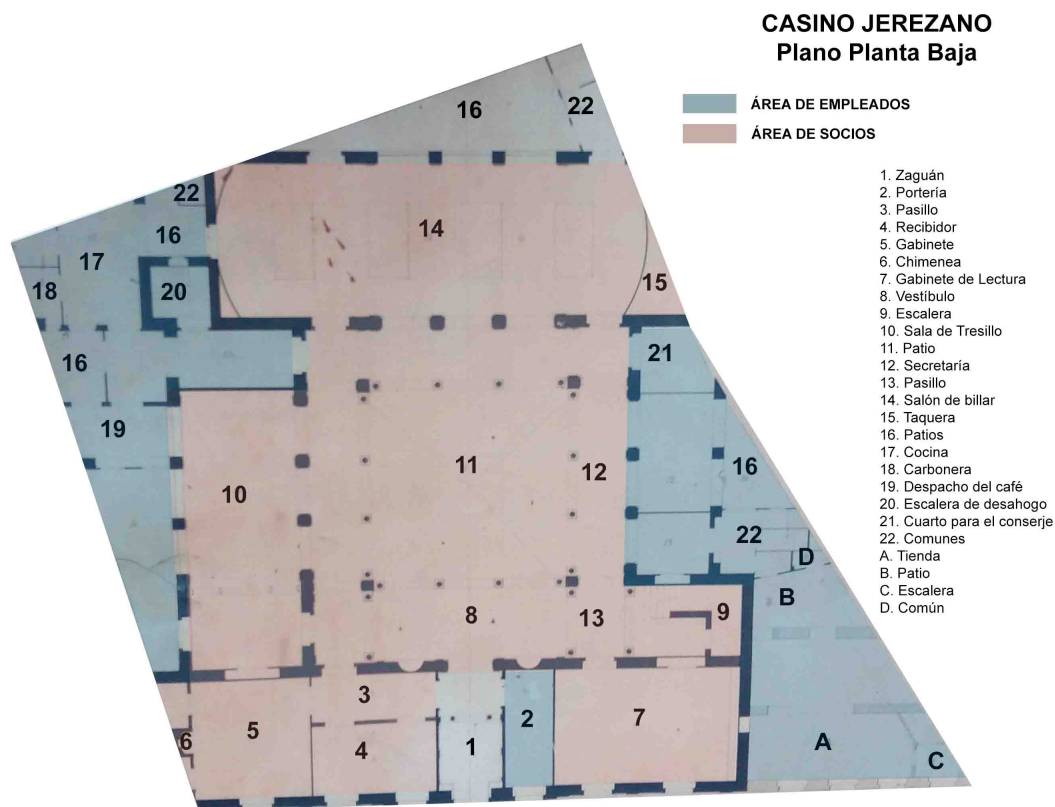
Plano de la planta baja del Casino Jerezano. Fuente: Elaboración propia en base a plano del AFGB.
